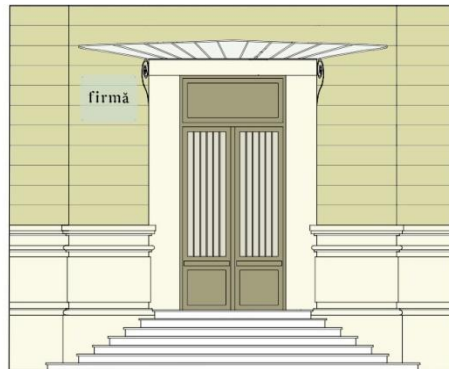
acces casă situată pe Strada Nicoae holban, Galați
